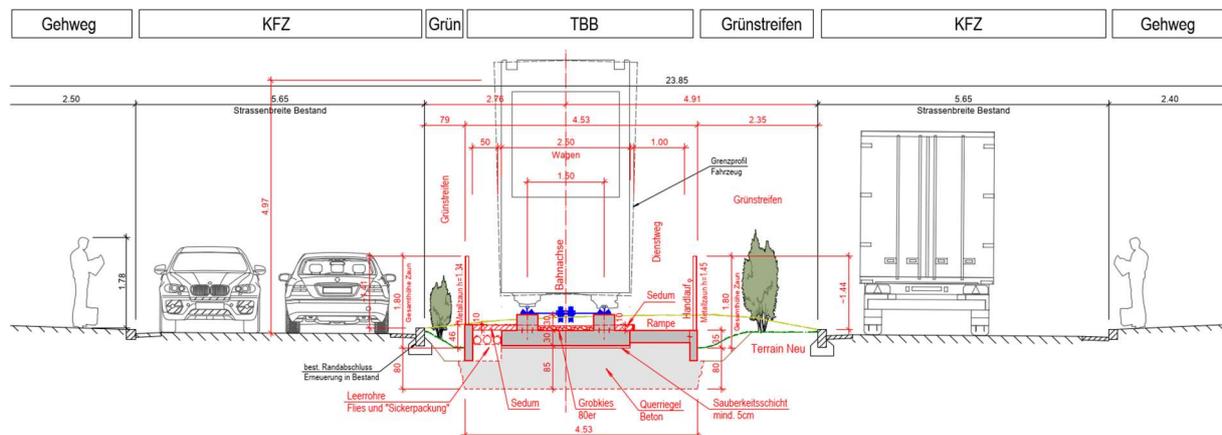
Querschnitt Fahrbahn im Bereich Bergbahnstraße (Quelle: Garaventa), siehe Anlage 4, Plan-Nr. 4202
